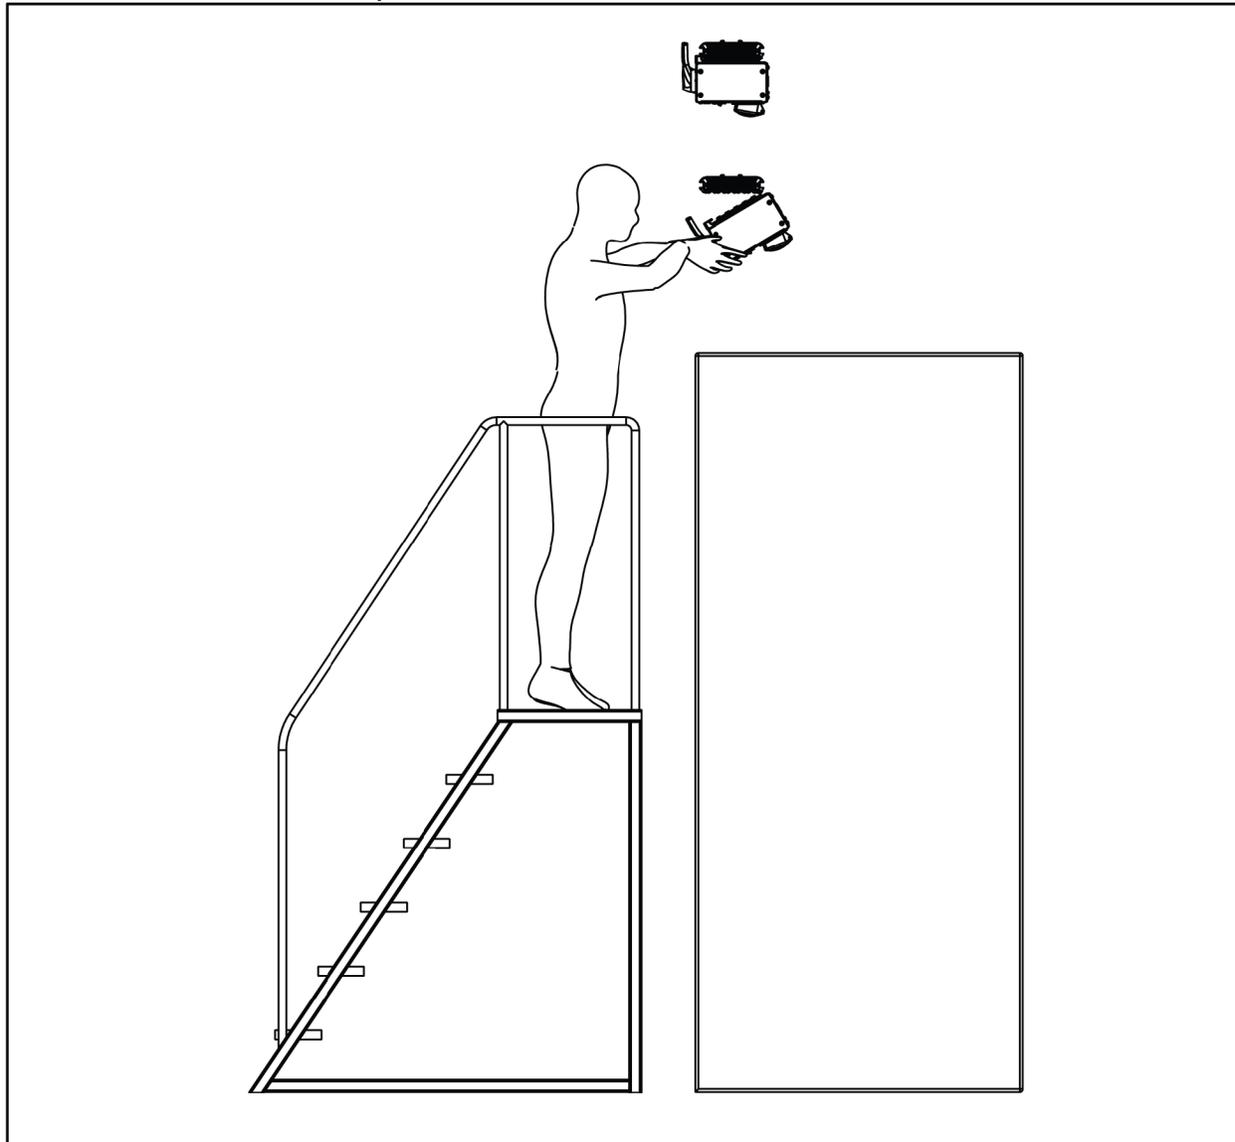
Esempio di installazione della cassetta di derivazione: sopra il rack con impianto doppio di blindosbarra orizzontale, a lato
